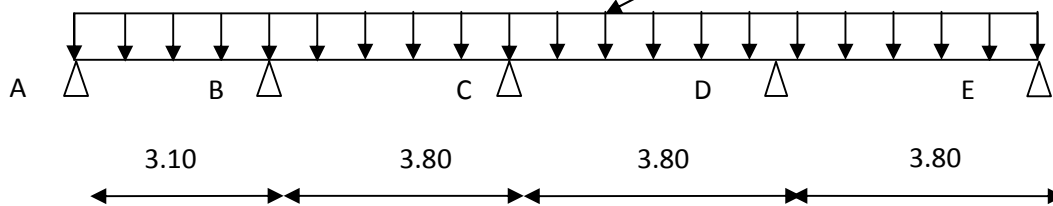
Schéma statique de la poutre continue reposant sur cinq appuis
